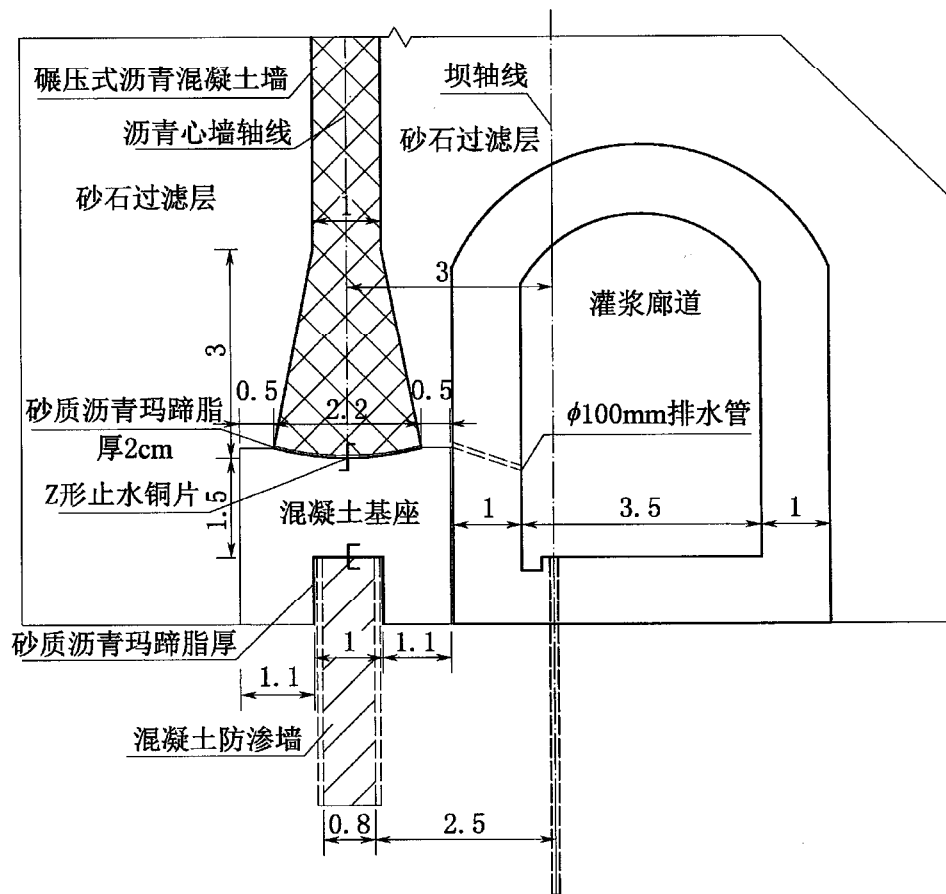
防渗墙与沥青心墙连接示意图 (单位: m)
